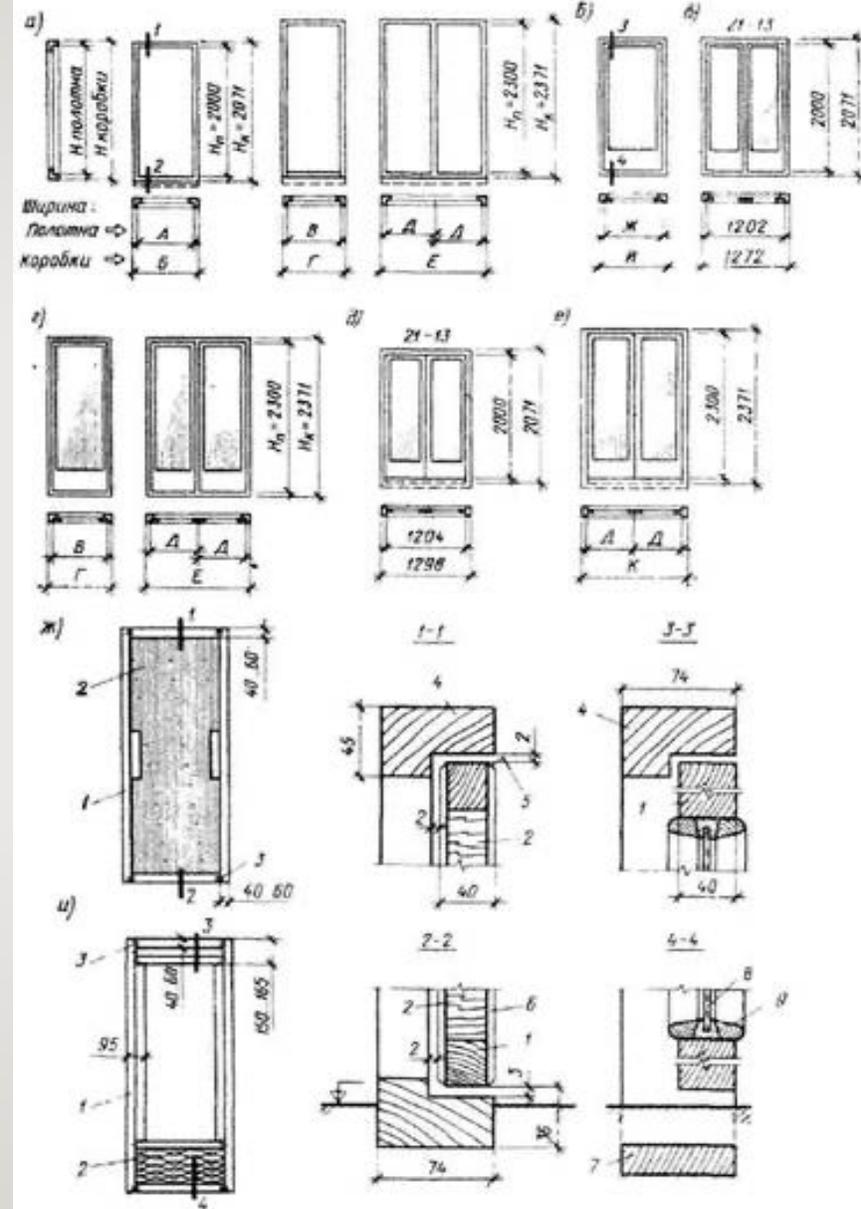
Двери деревянные внутренние щитовые для жилых и общественных зданий:
